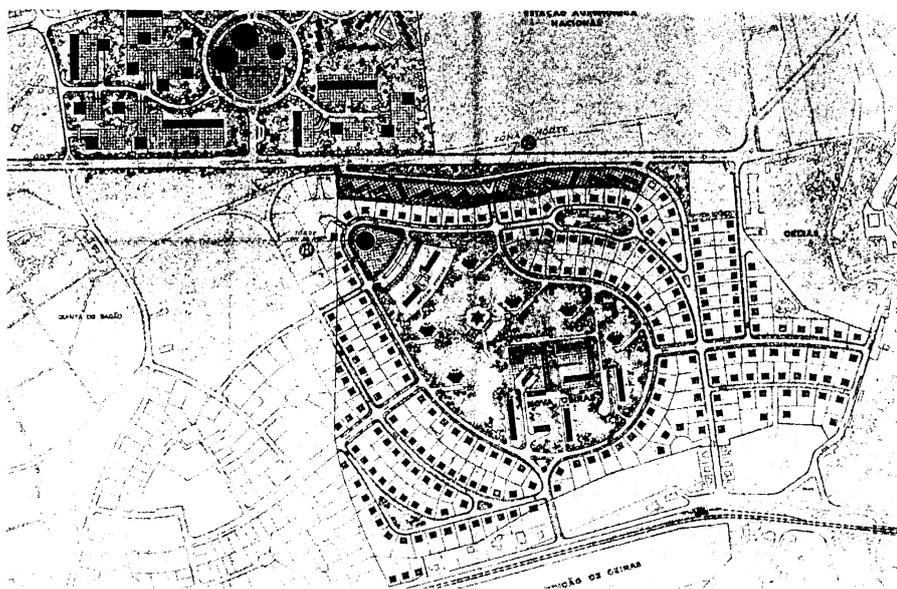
Plano de Urbanização da Quinta Grande (Nova Oeiras, em baixo) e da Quinta do Marquês (em cima) – Planta geral (1968)
